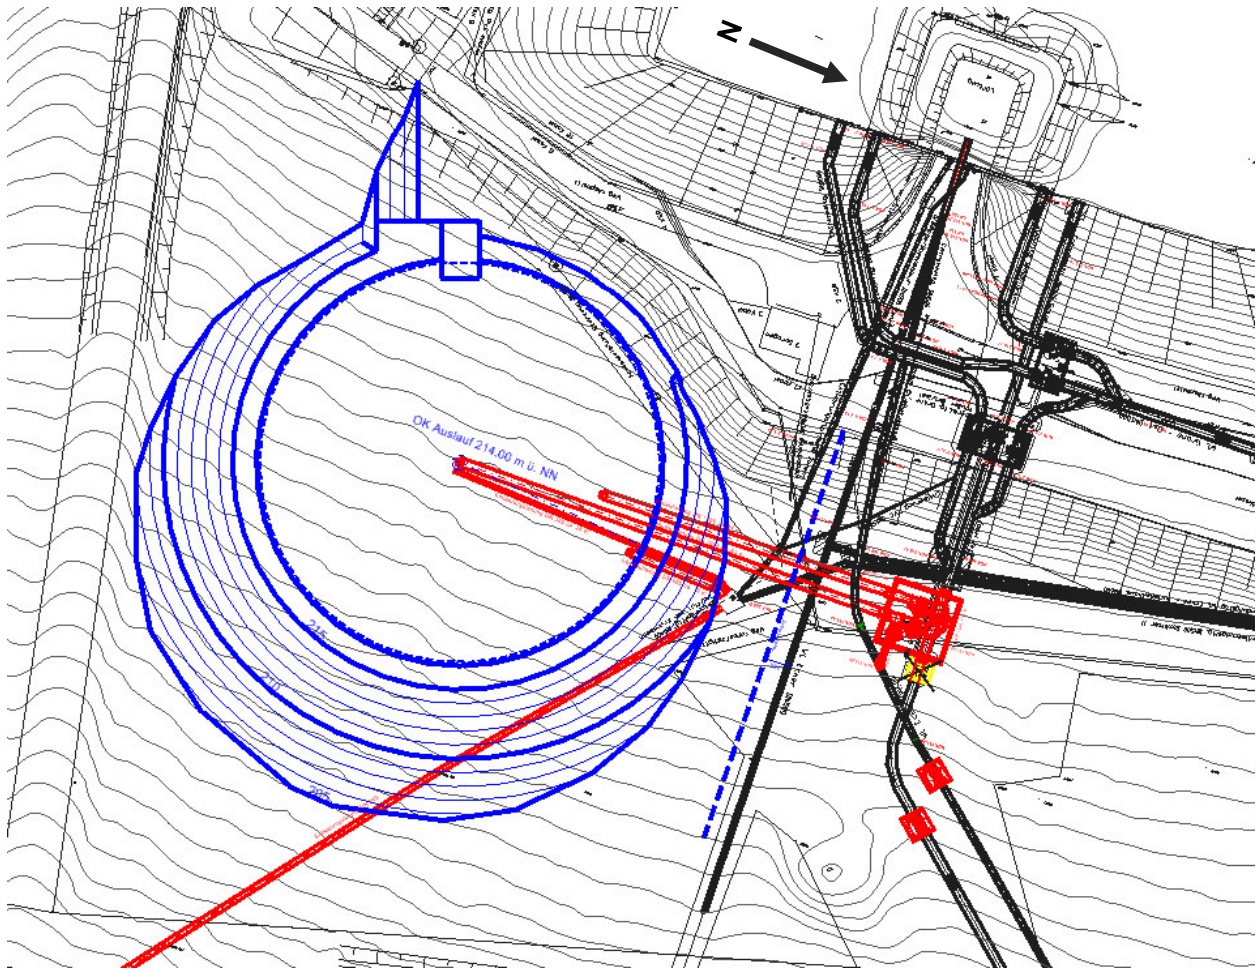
Variante C3: Lageskizze mit Rohrleitungen und Schachtbauwerken
